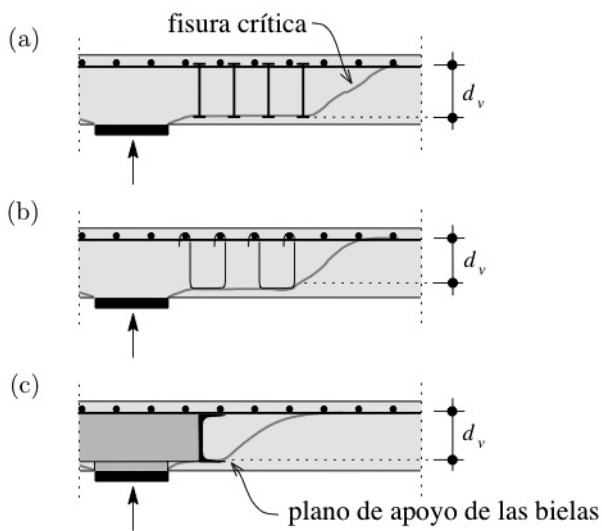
Punzonamiento al exterior de la zona con armadura transversal: (a) pernos; (b) cercos; y (c) cabezal metálico embebido
